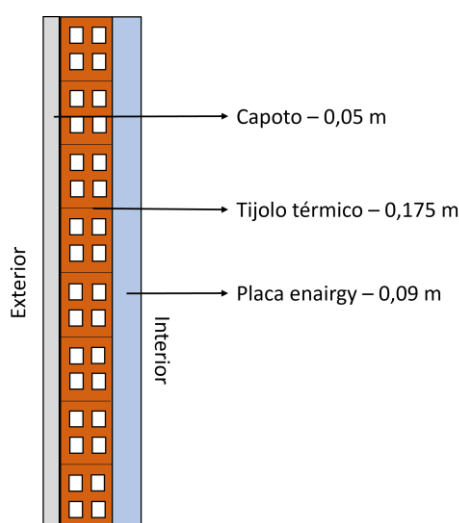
Corte transversal das paredes exteriores (não se encontra à escala)
